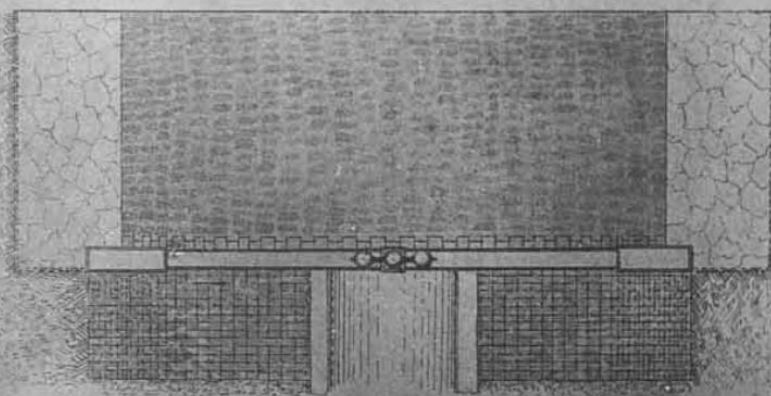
Elevação e metade da planta da Ponte David Campista, sobre o canal do Ribeirão Arrudas, na Praça da Estação.
